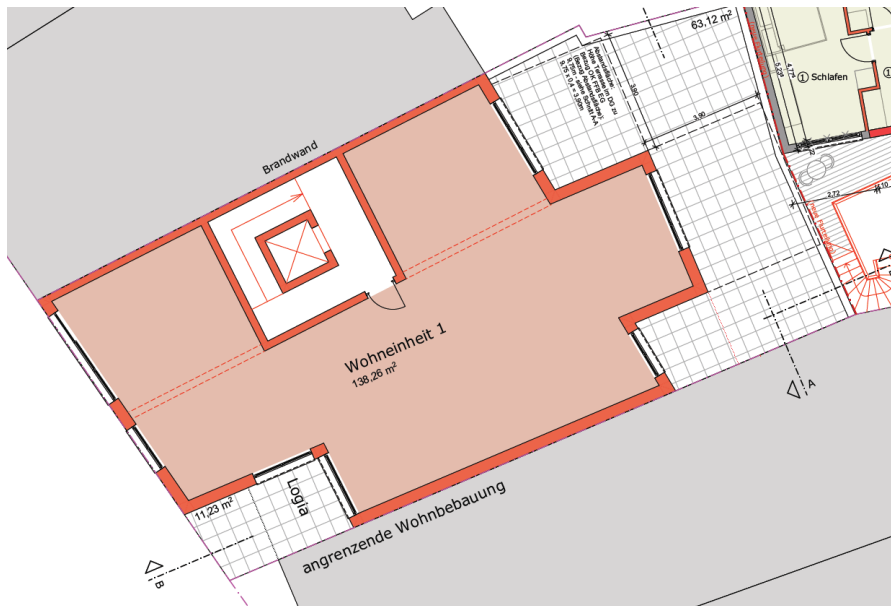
Obergeschoss mit Wohneinheit 1, Voranfrage [REDACTED] v. 08.12.2025
